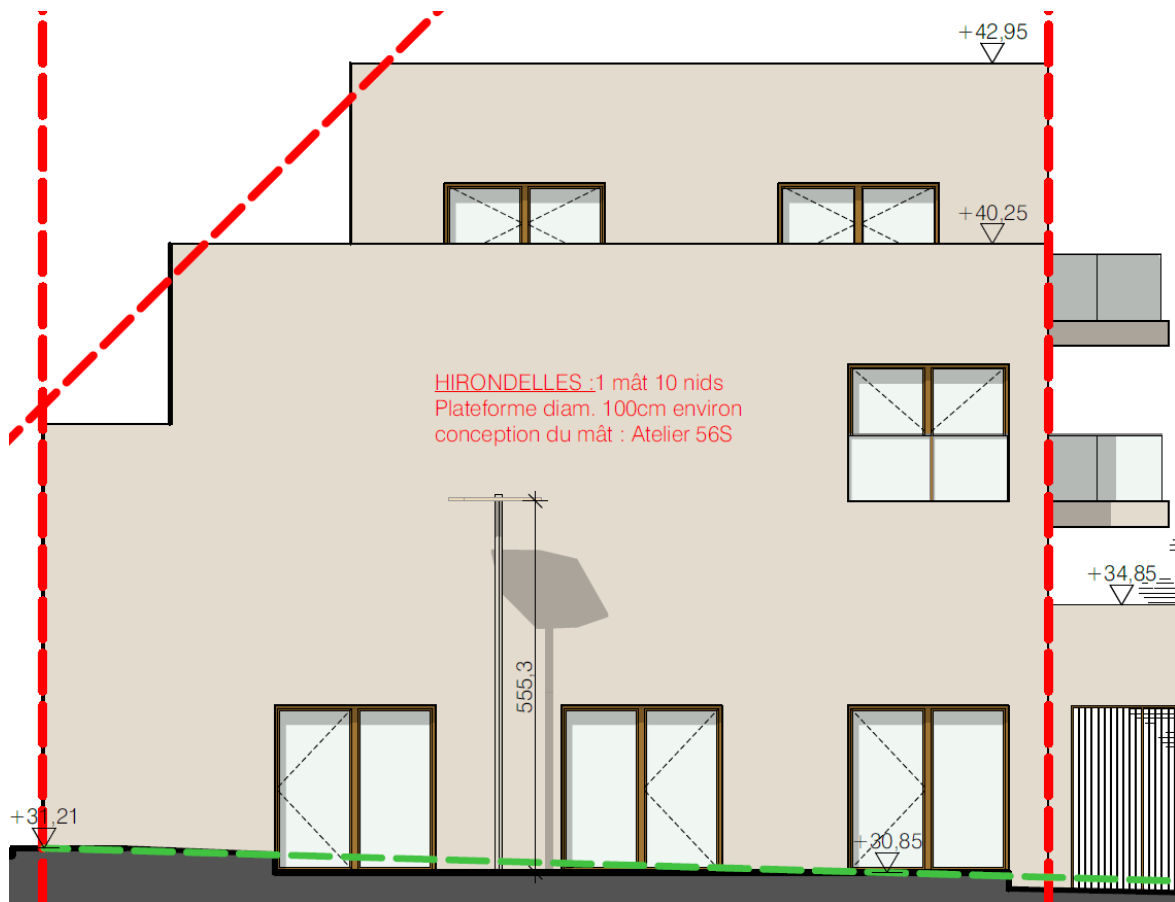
Zoom 2 sur la localisation du mât à hirondelle au sein de la venelle piétonne, façade ouest de la tranche 2 - Atelier 56S
